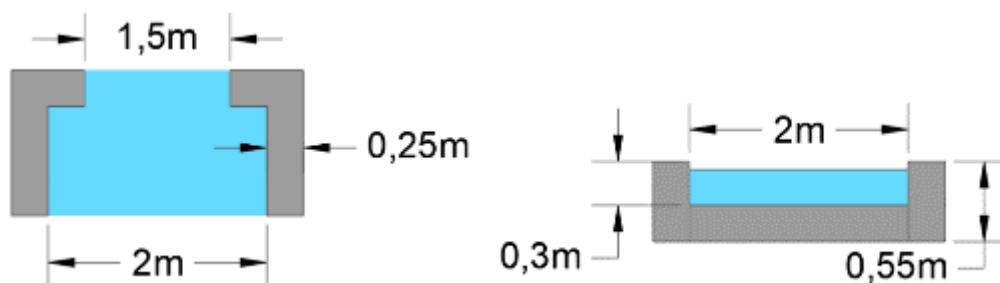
Detalls de la planta (esquerra) i de la secció transversal (dreta) de l'arqueta. Font: Pròpia
